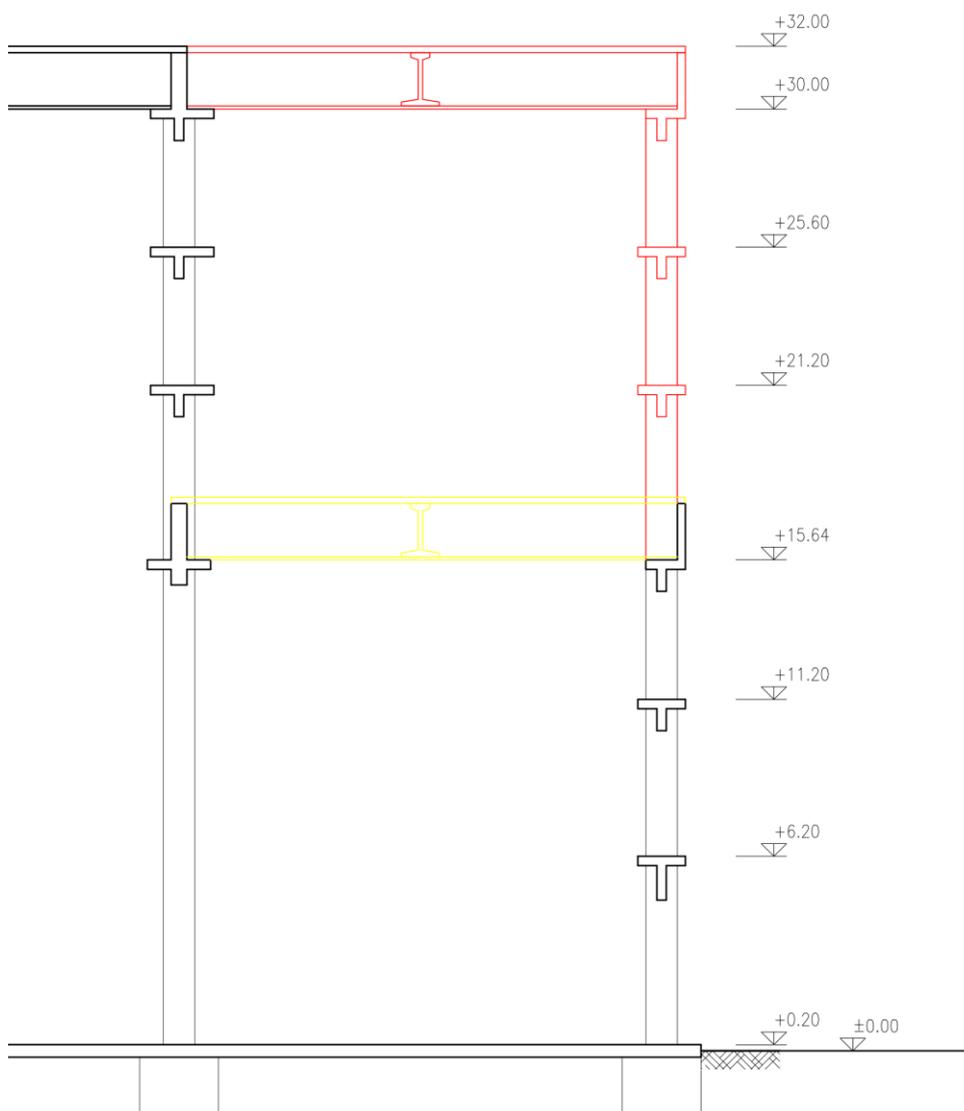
Sezione del fabbricato esistente con rappresentazione di massima dell'intervento di sopraelevazione
